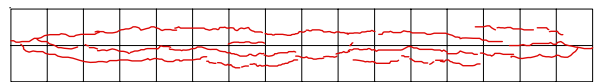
ひび割れ発生状況の例(既往試験体 No. 3-2³⁾)
